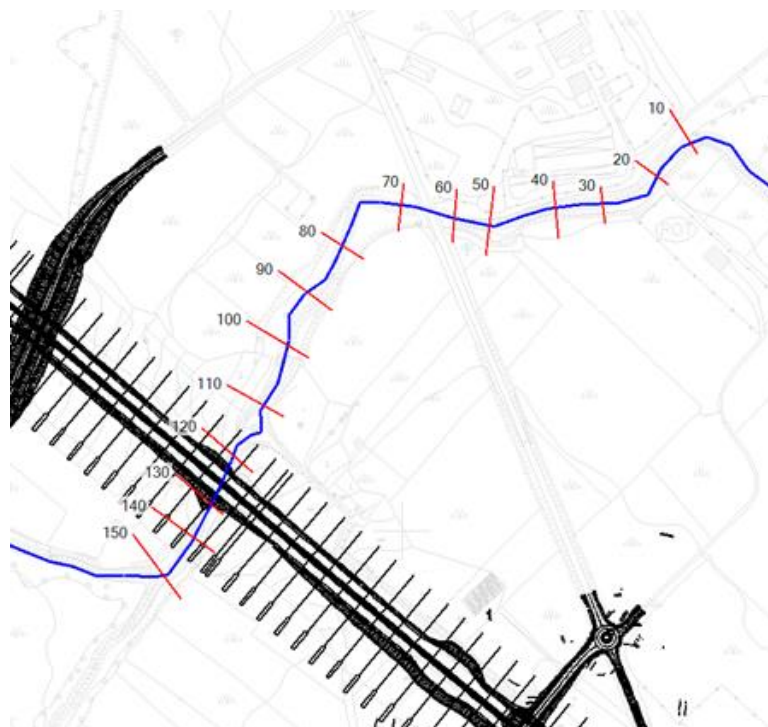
Inquadramento planimetrico della nuova opera VI22: sezioni modellate (planimetria modello idraulico)
